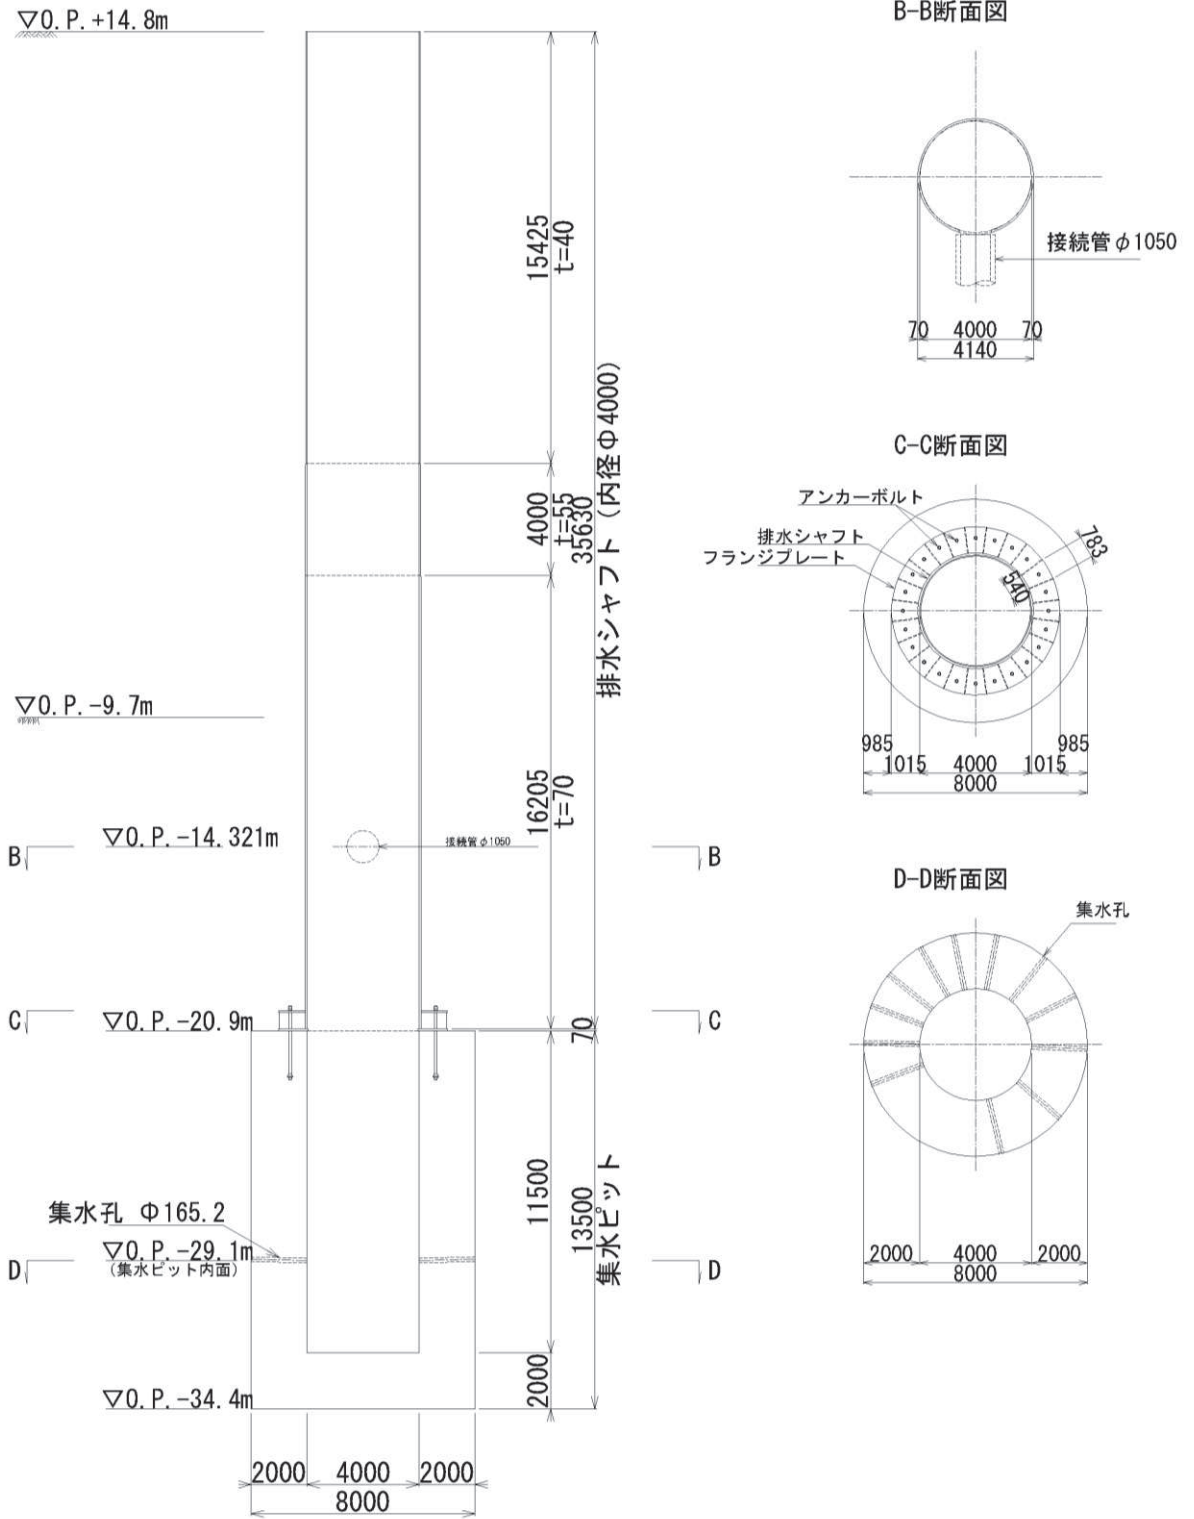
(2) No.2 揚水井戸 構造図 (単位 : mm)
